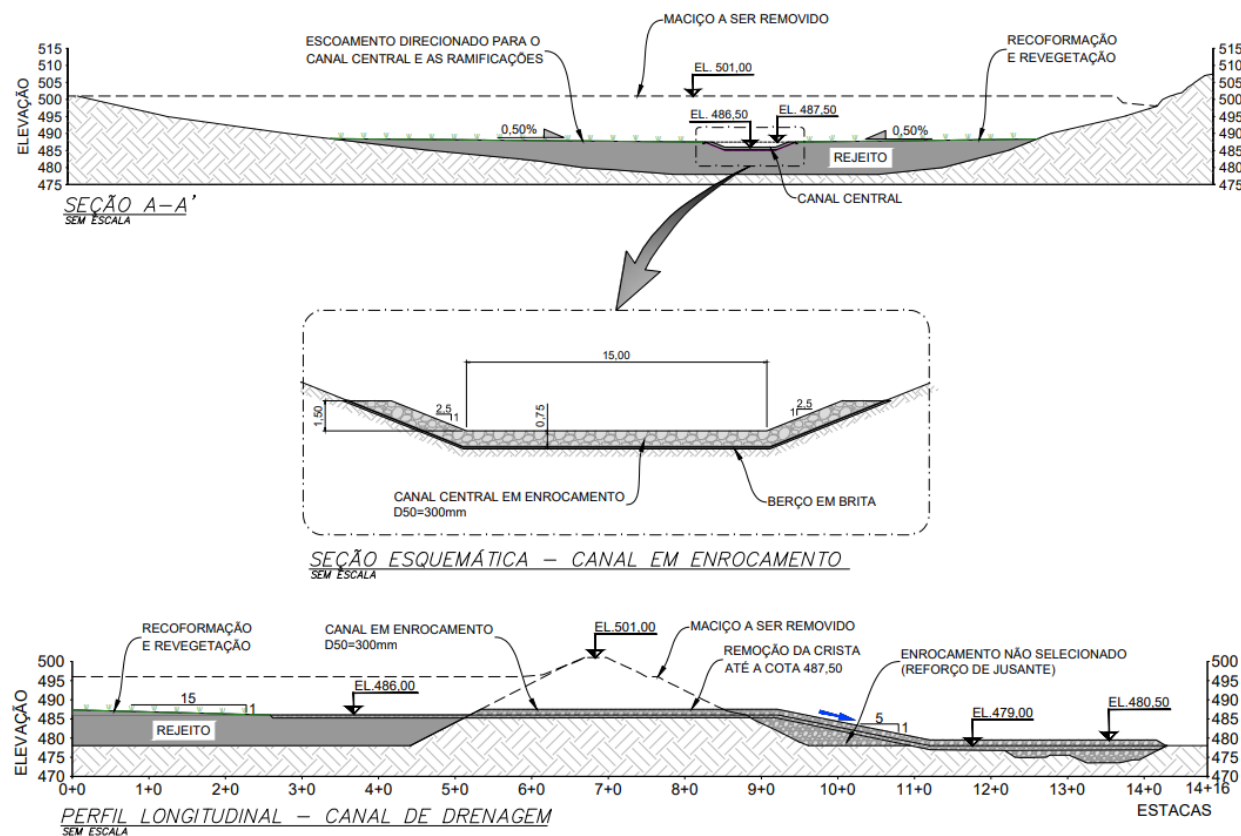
Croqui esquemático descaracterização (Alternativa 2)
